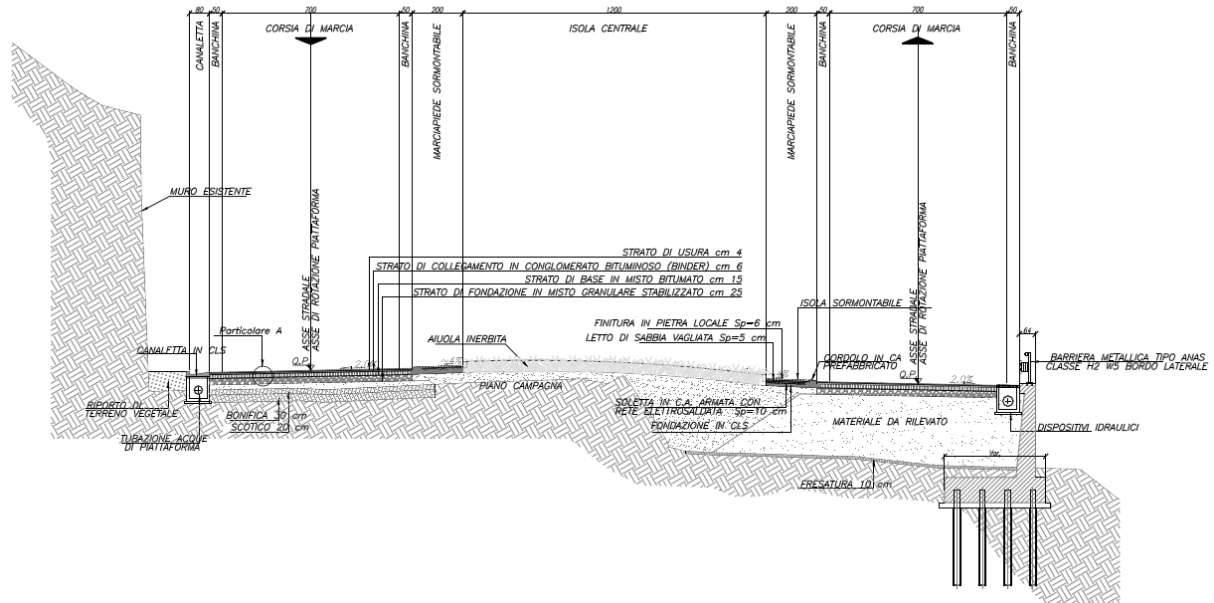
sezione tipo rotonda svincolo lato Umbria, con marciapiede sormontabile.
